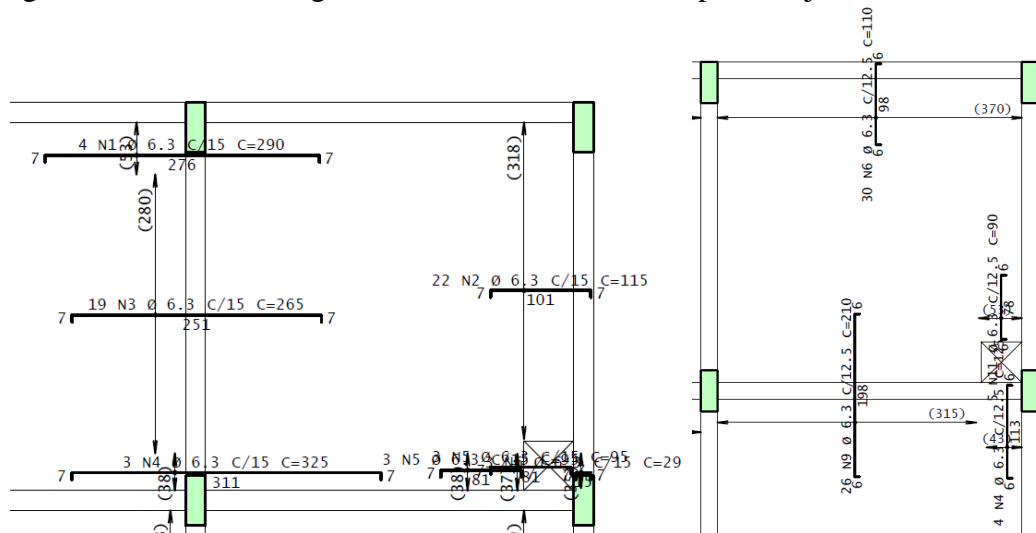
Armaduras positivas horizontais e verticais para a laje LA 50/50-01.
